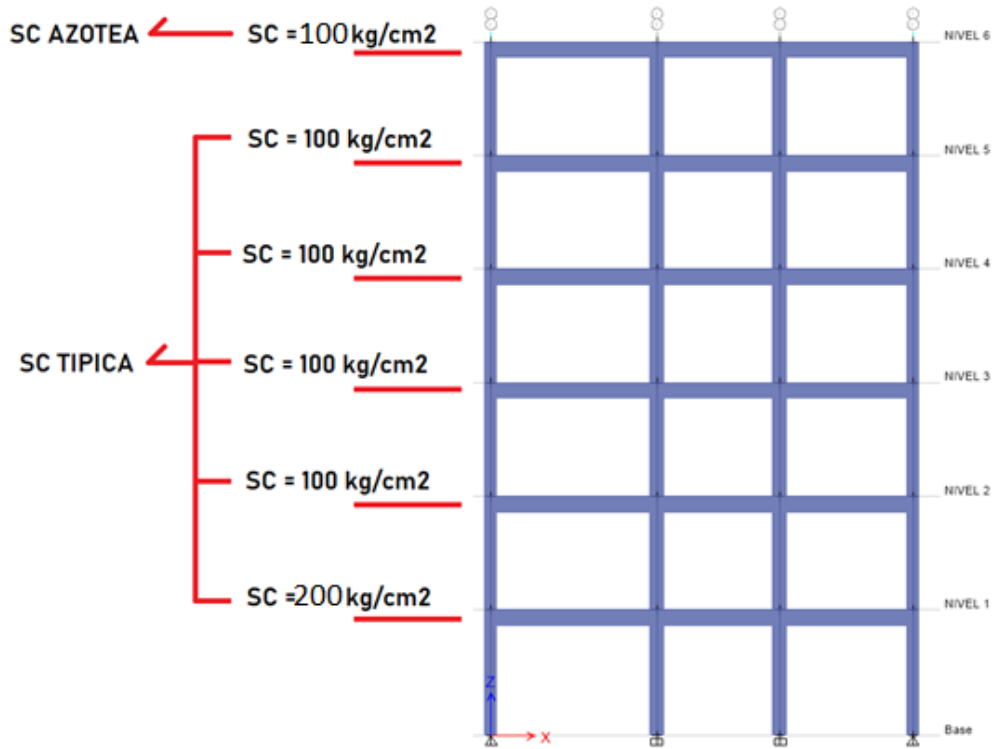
Vista de elevación con las sobrecargas en Etabs.
